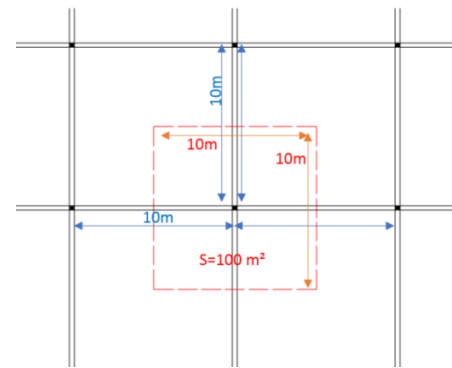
surface du plancher supportée par la colonne la plus sollicitée
